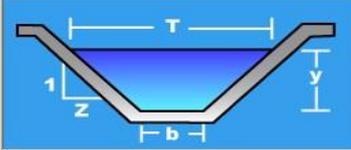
Cálculo De Canal De Conducción Abierto De Concreto - c
